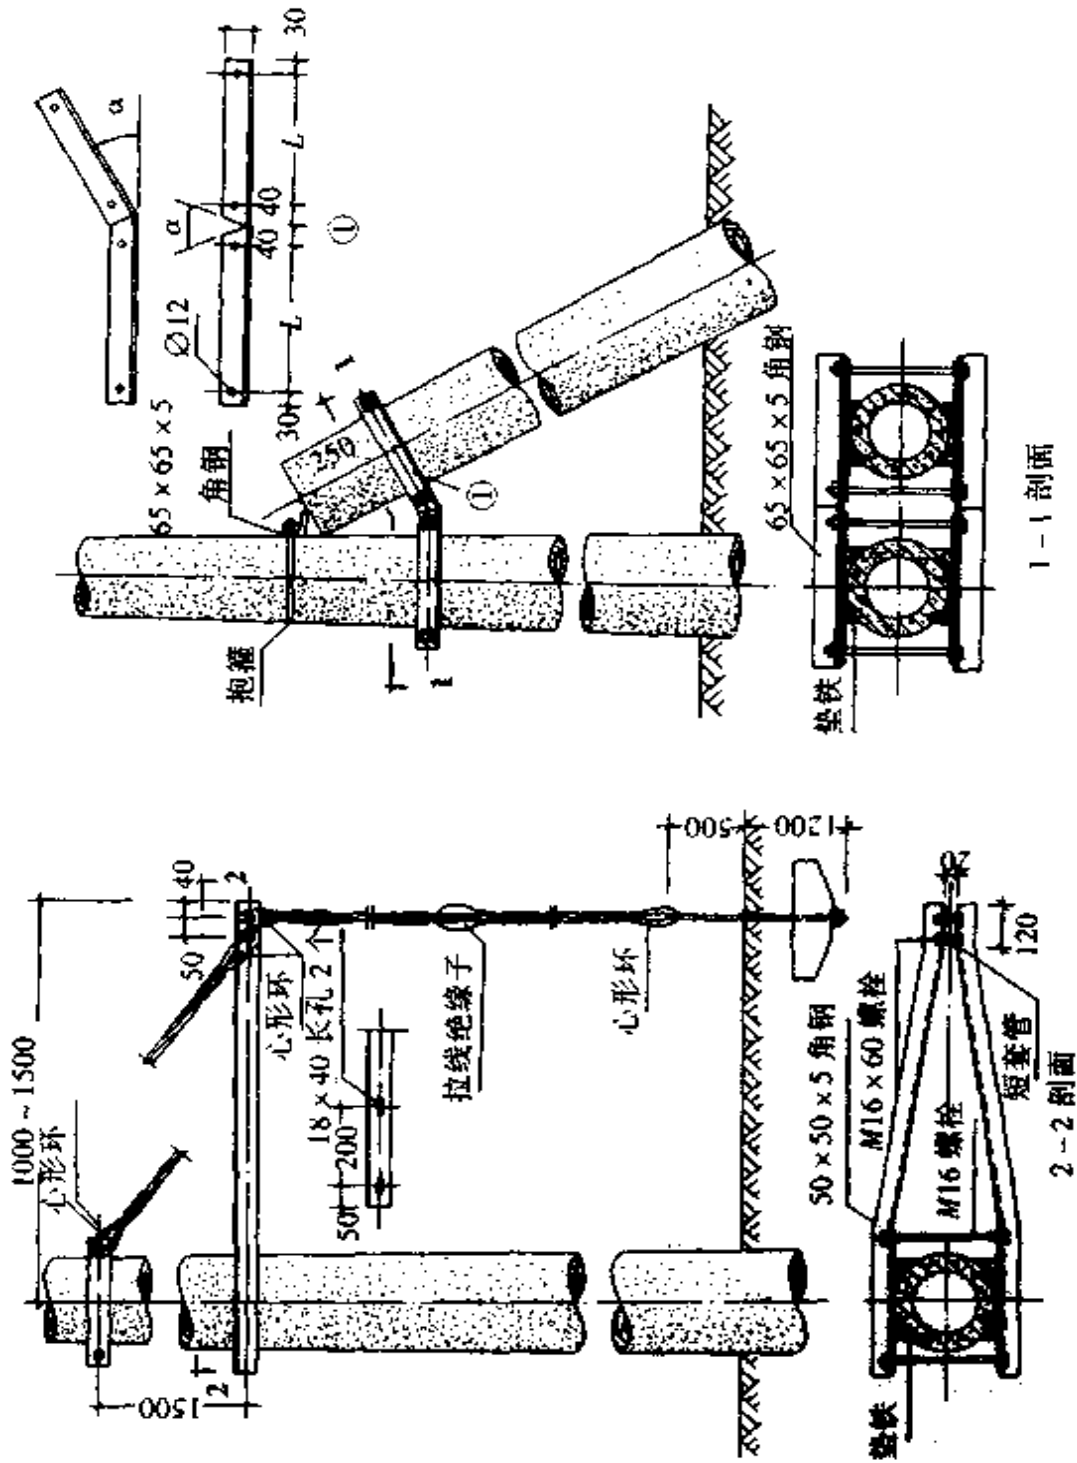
钢筋混凝土电杆自身拉线及线杆做法图
